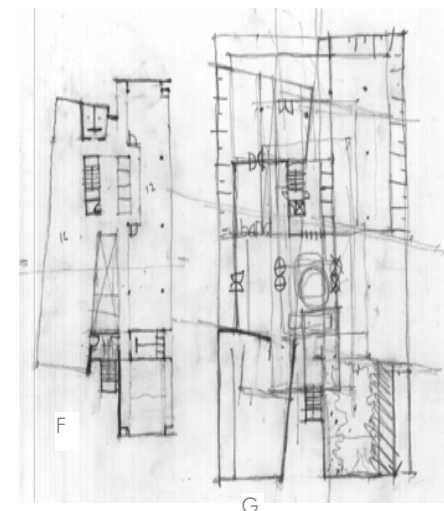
[ampliação parcial da figura 142]: Planta andar tipo (F) e pavimento térreo (G).
